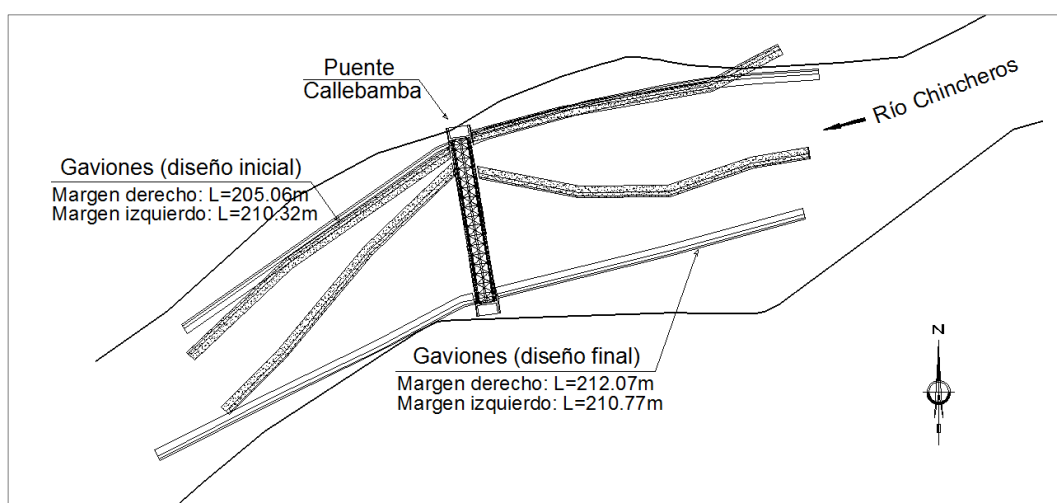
Vista en planta del puente Callebamba, ubicación de gaviones inicial y final sobre el río Chincheros.
